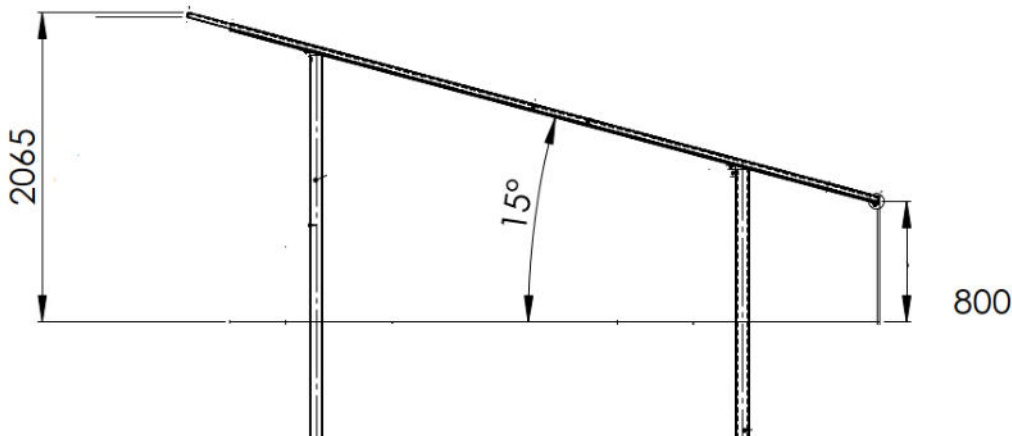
Skizzen der Modulkonstruktion (Quelle: Planungsunterlagen)
